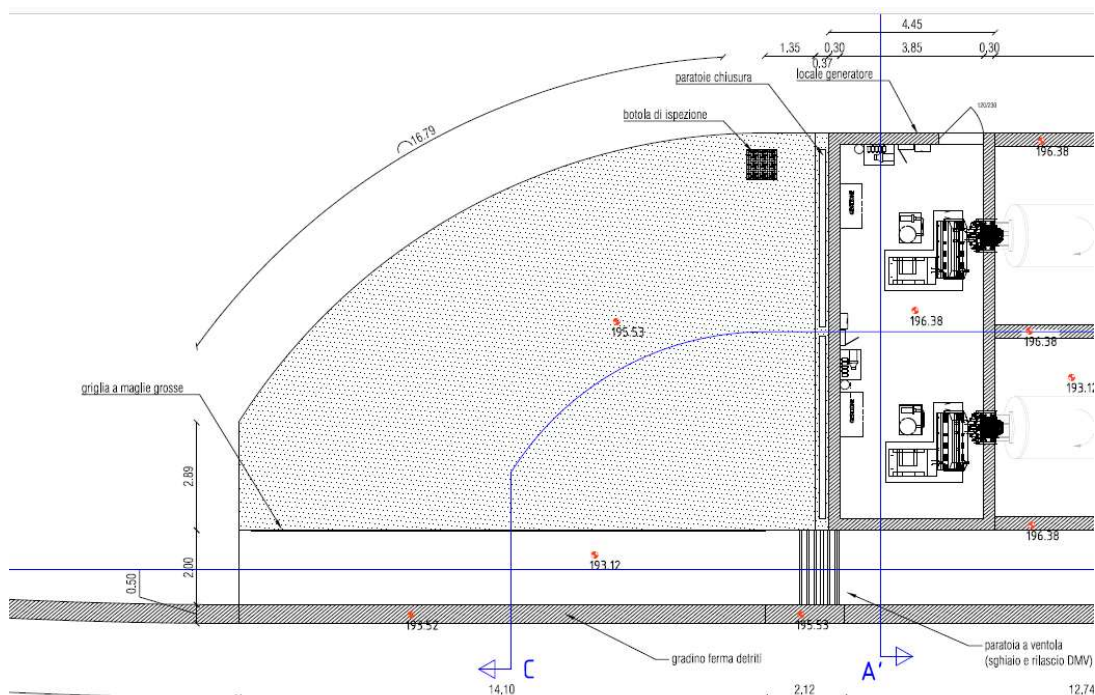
Estratto planimetrico opera di presa e canale di derivazione.
